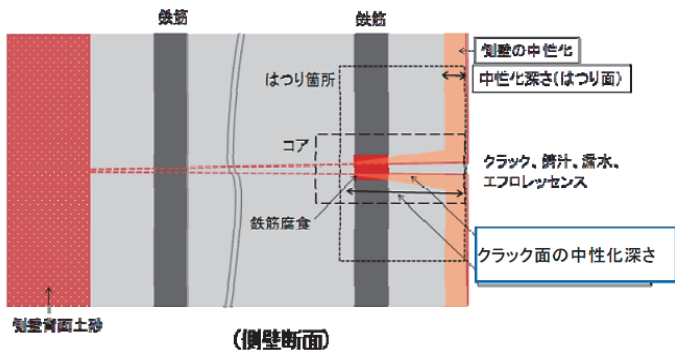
ひび割れ面からの鉄筋腐食のイメージ
